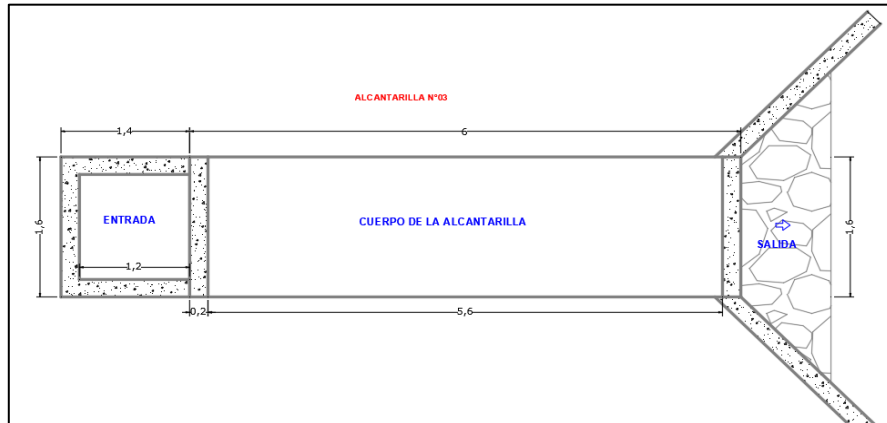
Vista en planta de la alcantarilla N°03 existente.
